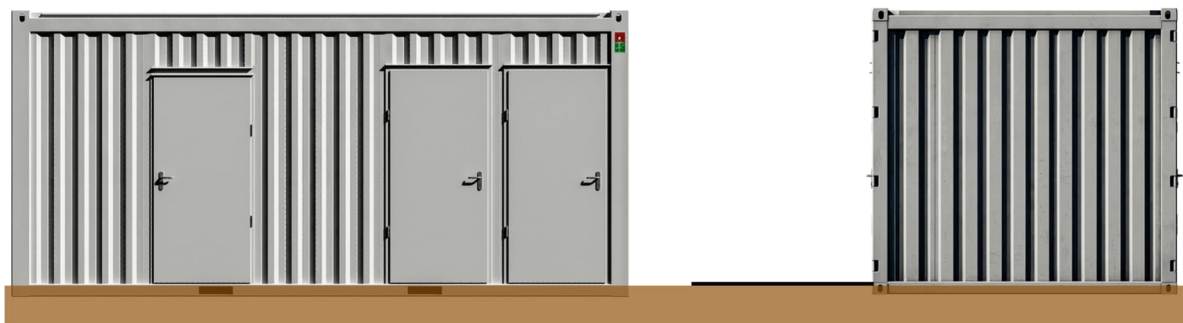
Bodenaufschüttung mit befahrbarer Platte
